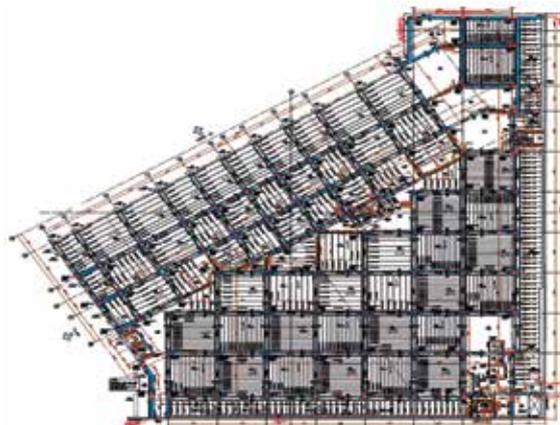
Layout do shopping center do complexo Parque da Cidade.
